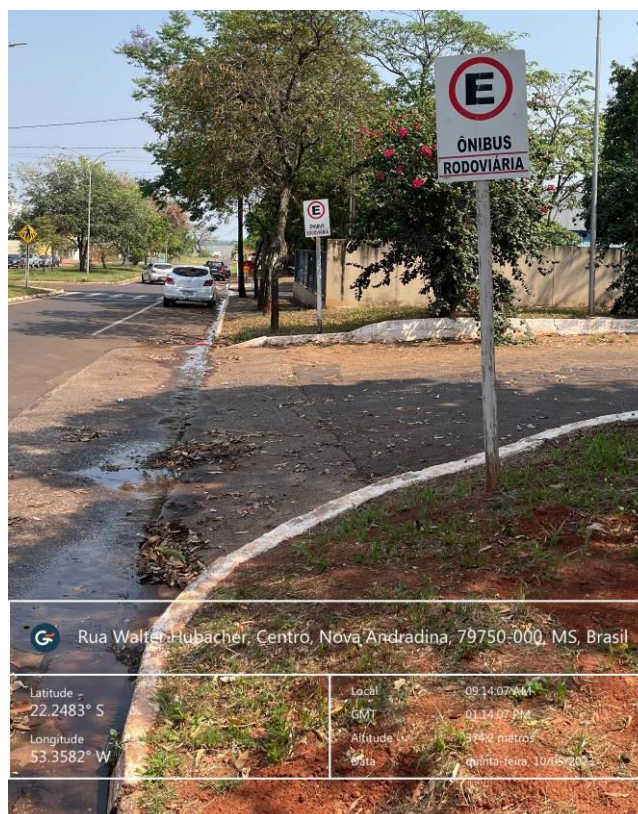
Detalhamento travessia sem rampa de acessibilidade e com obstrução – R. Antônio Joaquim de Moura Andrade
